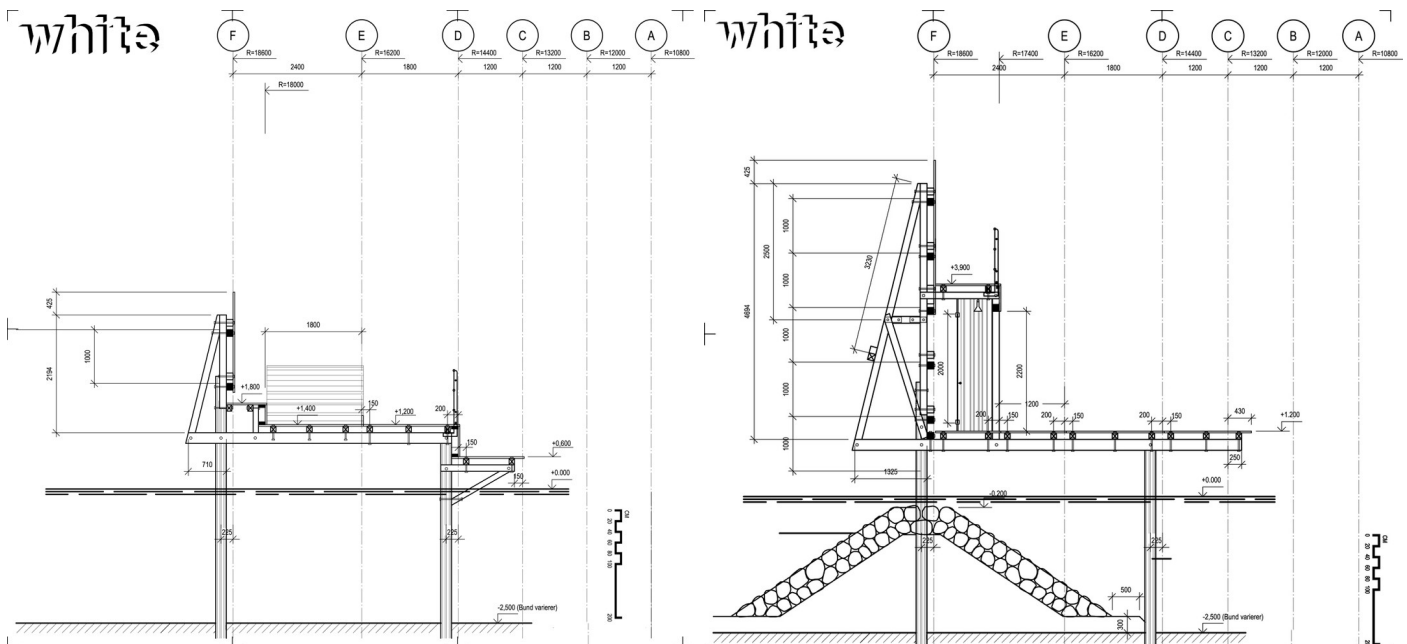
Secciones constructivas del pabellón marítimo. En estos podemos apreciar la escollera artificial bajo el nivel del agua y el sistema porticado en estructura mixta acero-madera.
